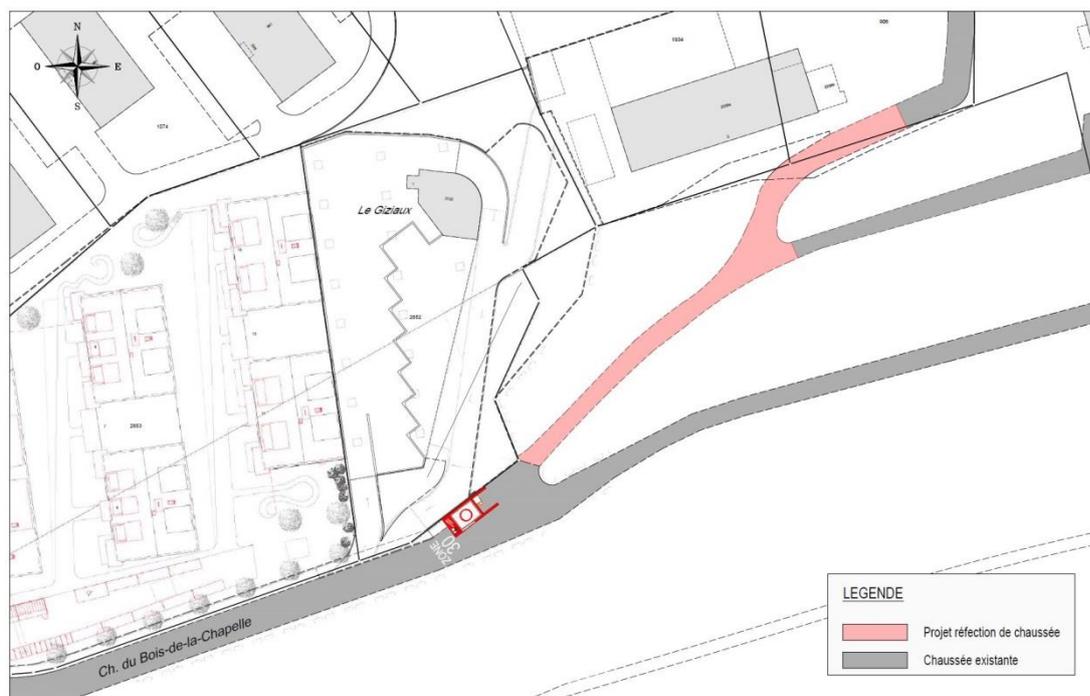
Plan des travaux sur le Ch. du Bois-de-la-Chapelle
